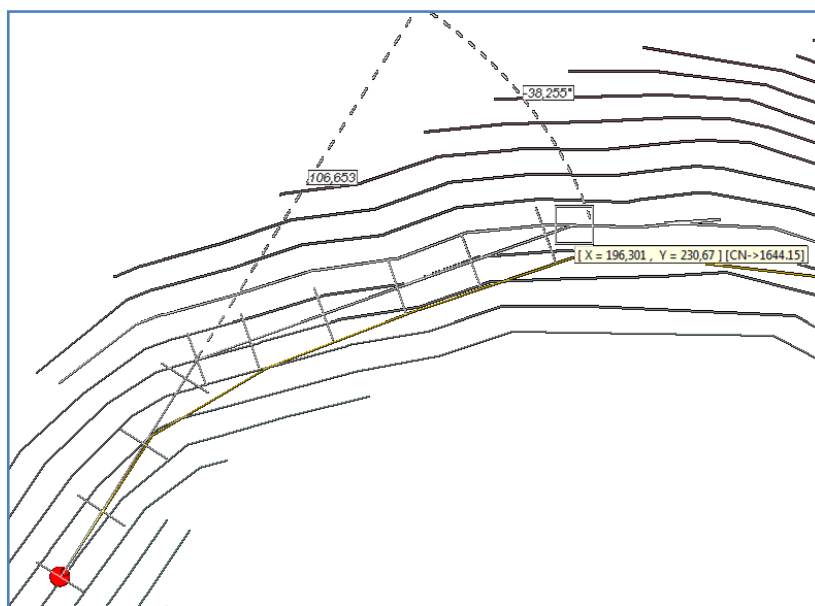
Trazado de la línea de proyecto Digravi Fase II
